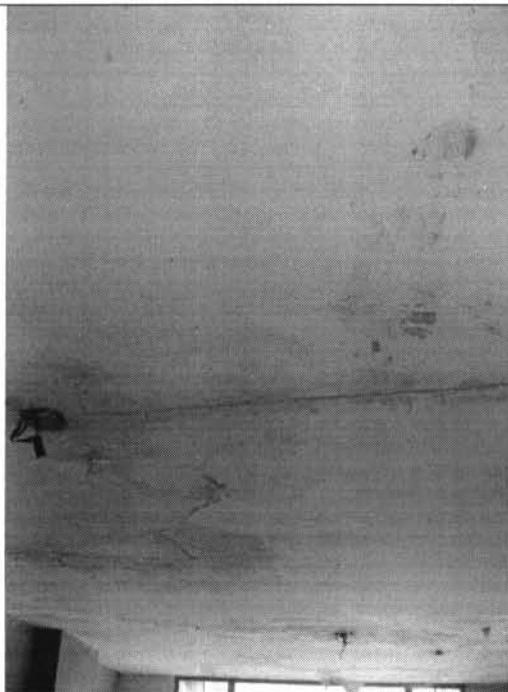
Fisuras en la parte inferior de la placa de tercer piso.
